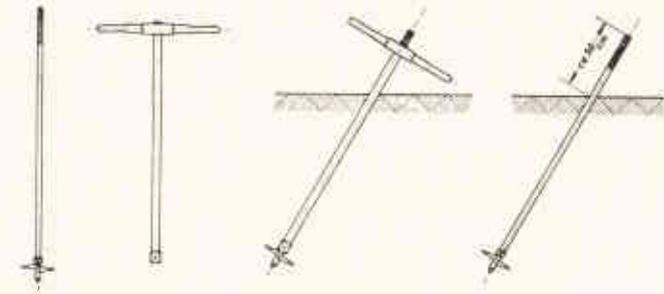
Schraubanker und Steckschlüssel für Schraubanker
